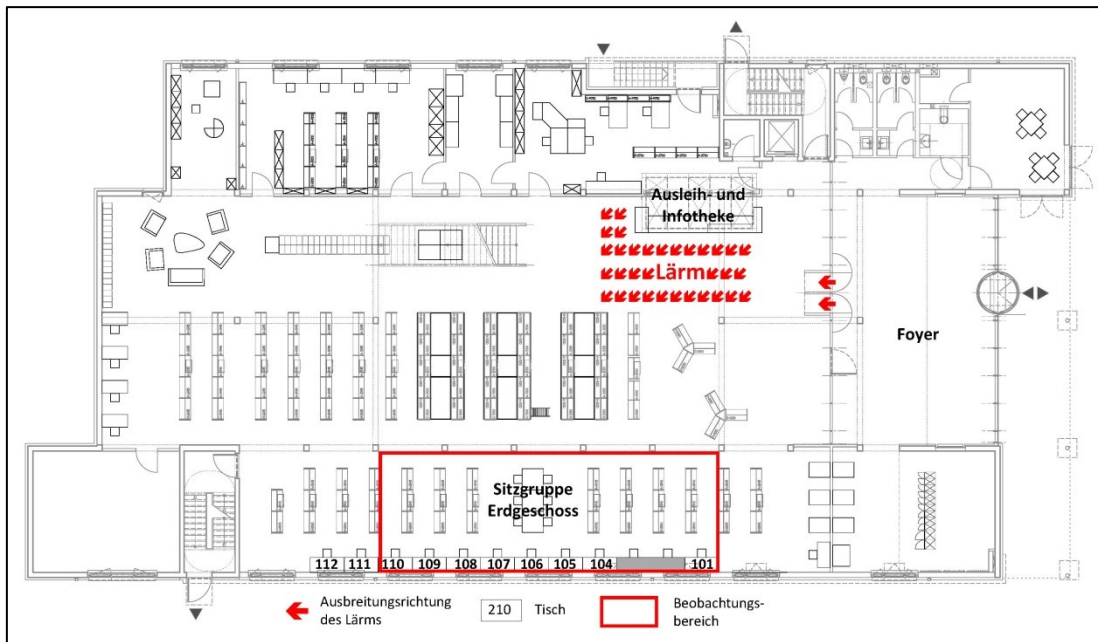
Raumplan des Erdgeschosses der HSB Friedensau mit Beobachtungsbereich
